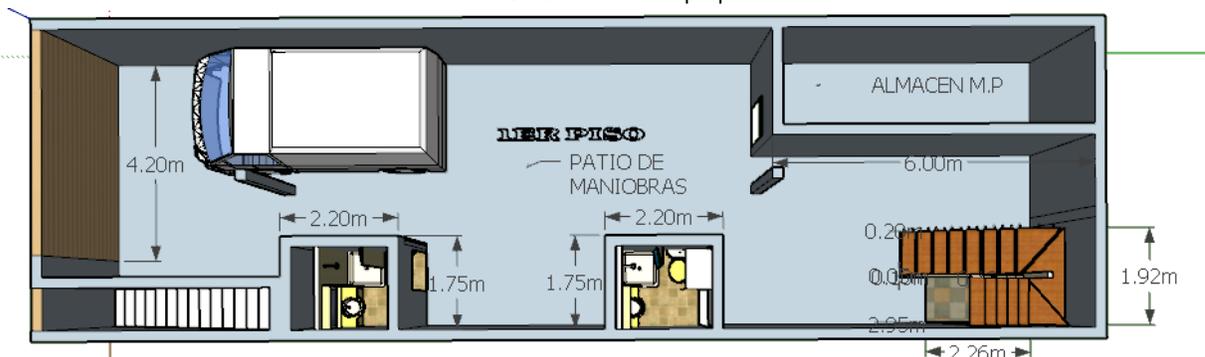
Plano primera planta de "Multiservicios Caladri S.A.C"
